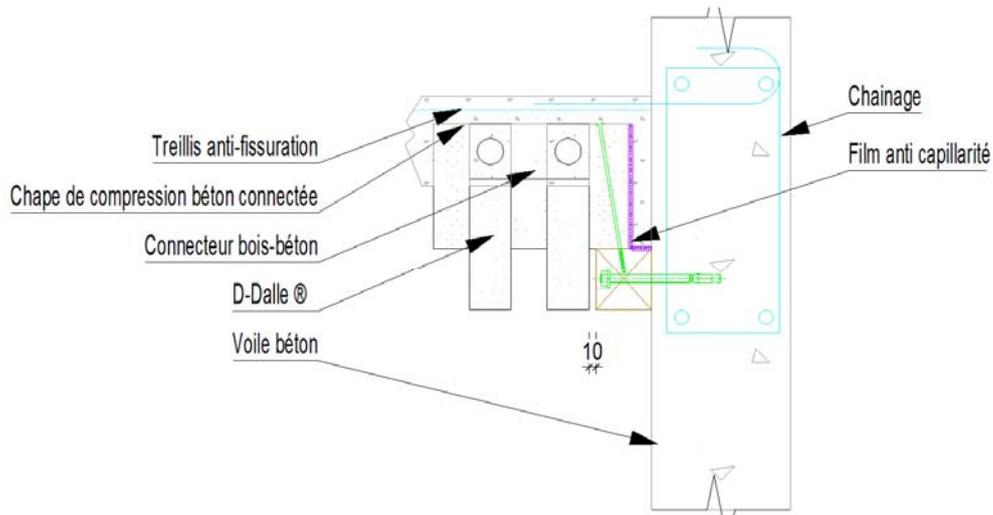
Coupe transversale – détail d'appui sur muraillère bois
